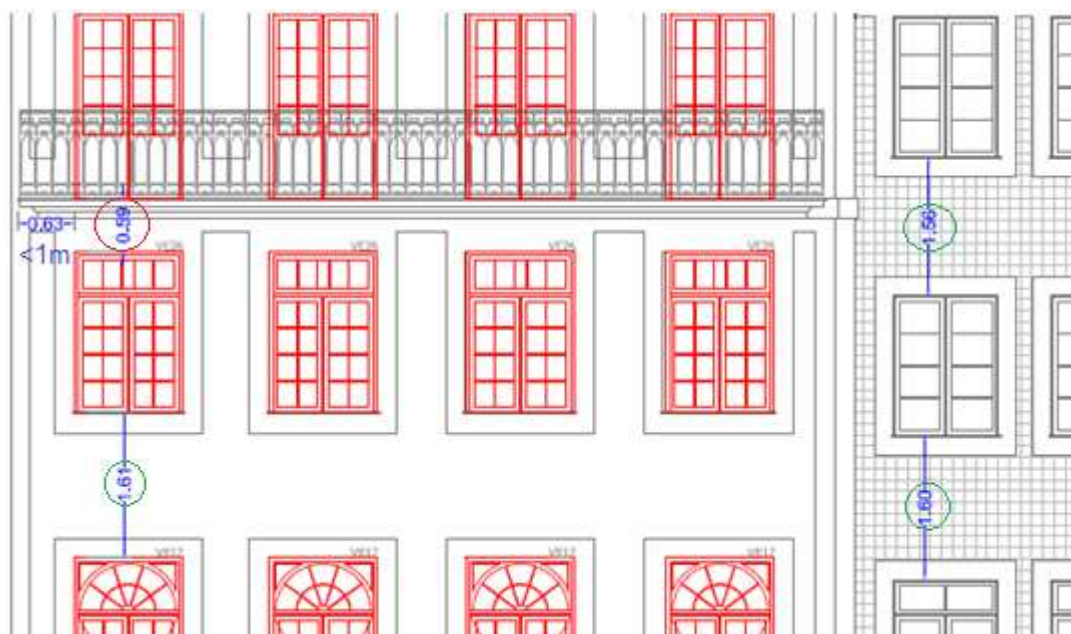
Pormenor da fachada: Distância entre vãos
